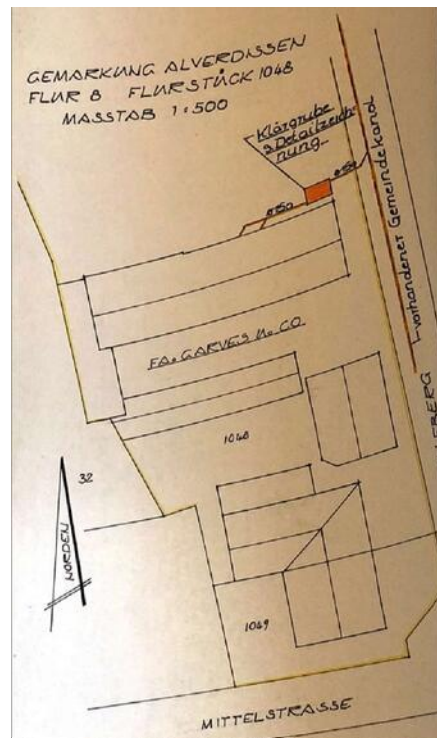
Entwässerungsplan zum Antrag aus dem Jahr 1965 für den Einbau einer Toilettenanlage auf dem Flurstück 106 (Filleberg 3). Die geplante Klärgrube mit Anschluss an den vorhandenen Gemeindekanal liegt unmittelbar an der nordöstlichen Gebäudeecke des Fabrikgebäudes und damit auf dem Flurstück 490.
